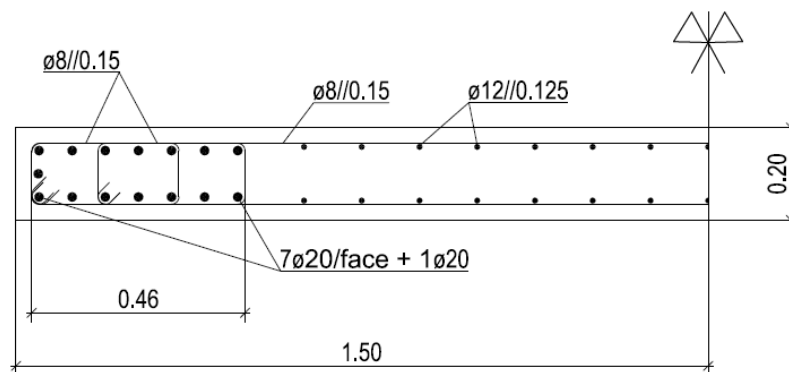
Armadura longitudinal e transversal para as paredes Pa1 a Pa4 para o nível 3
